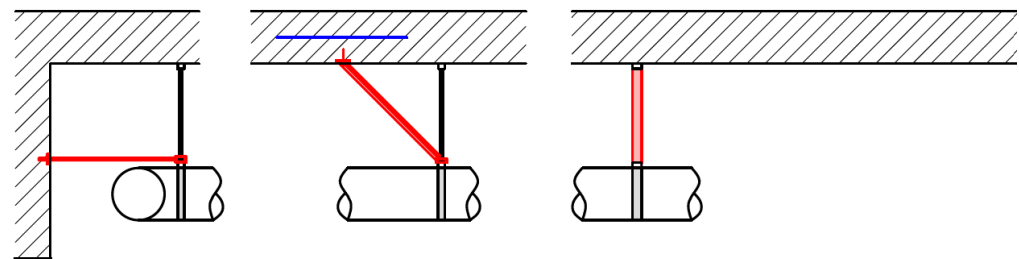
Principe de rigidification des conduites dans le sens longitudinal et transversal
